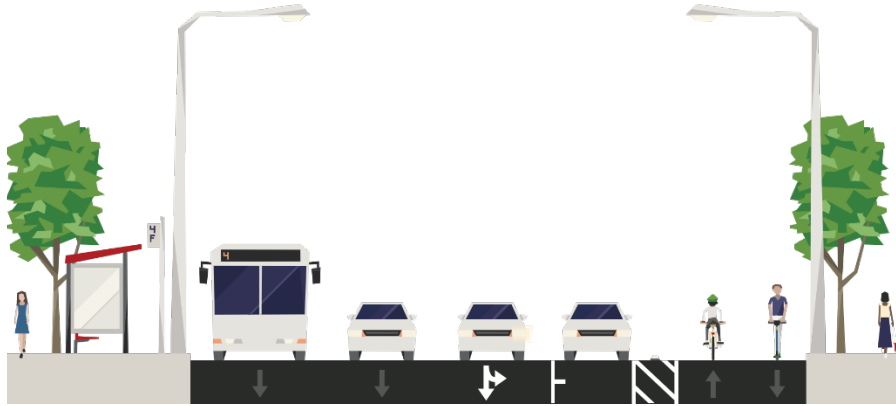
Carril bici segregado en calzada con tachos como elemento de resguardo a aparcamiento en línea. Fuente: Elaboración propia Streetmix.
